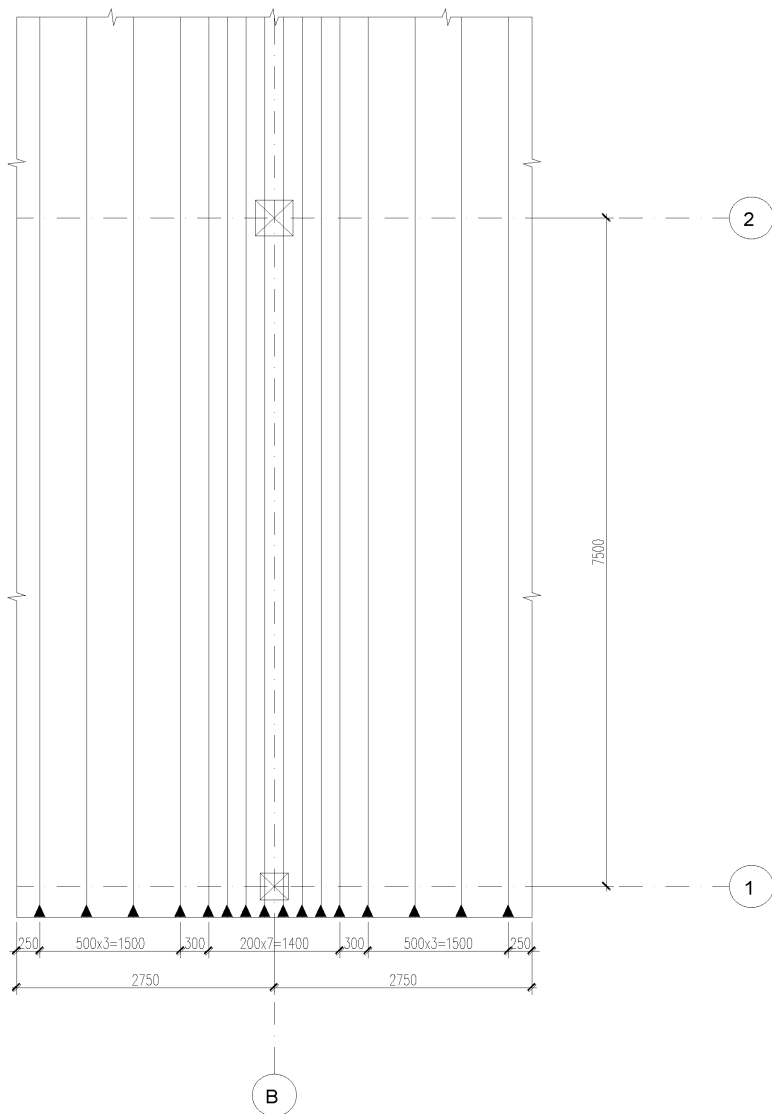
Конструирование расположения арматурных элементов вдоль буквенных осей
